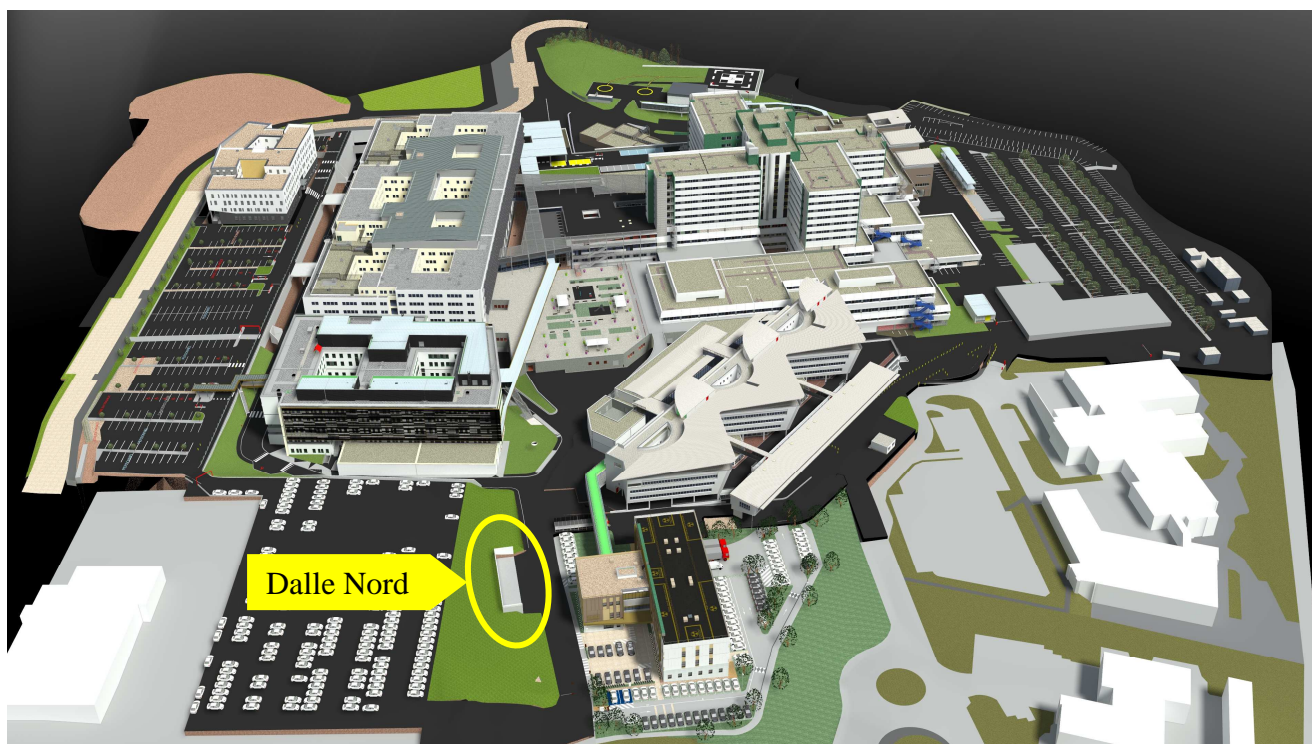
Vue du site Jean Minjoz du CHU de Besançon (3 Boulevard Fleming)
